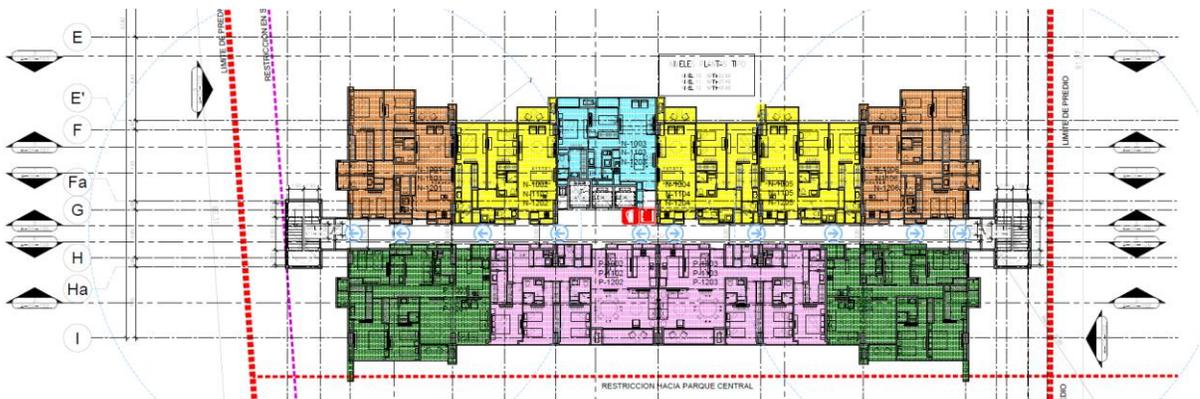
PLANTA NIVEL 10, 11 Y 12.
